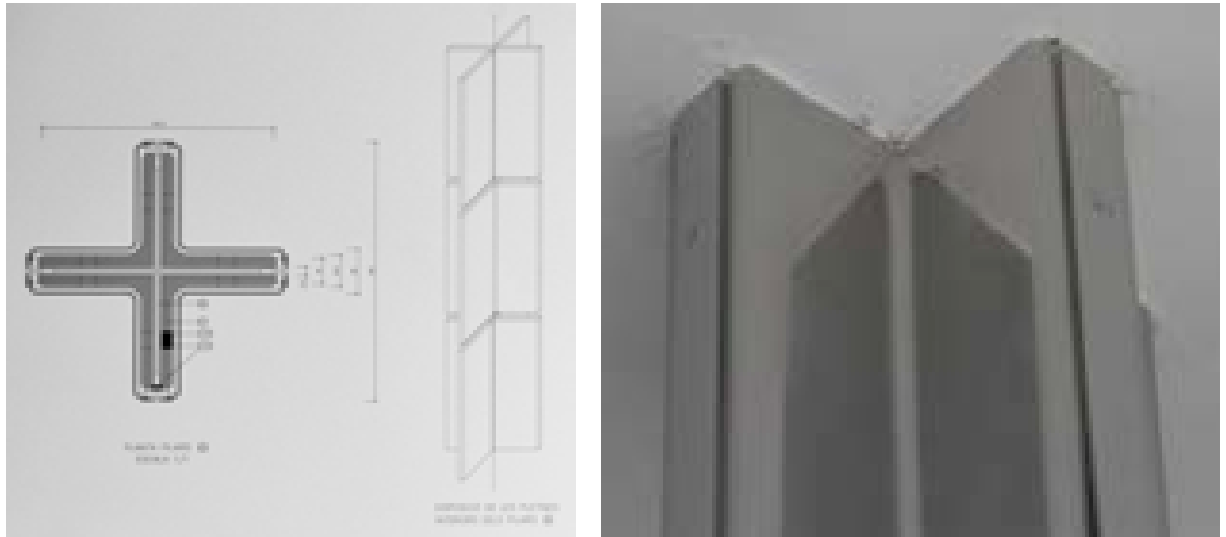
Sezione tipo del pilastro cruciforme e disposizione dei piatti metallici³⁸
